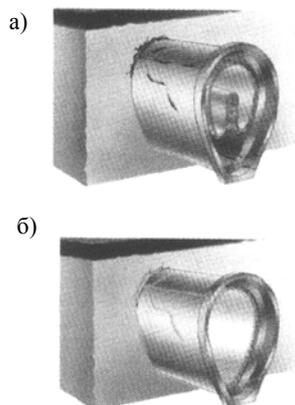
Схема установки полиэтиленового рукава в коллекторе.
